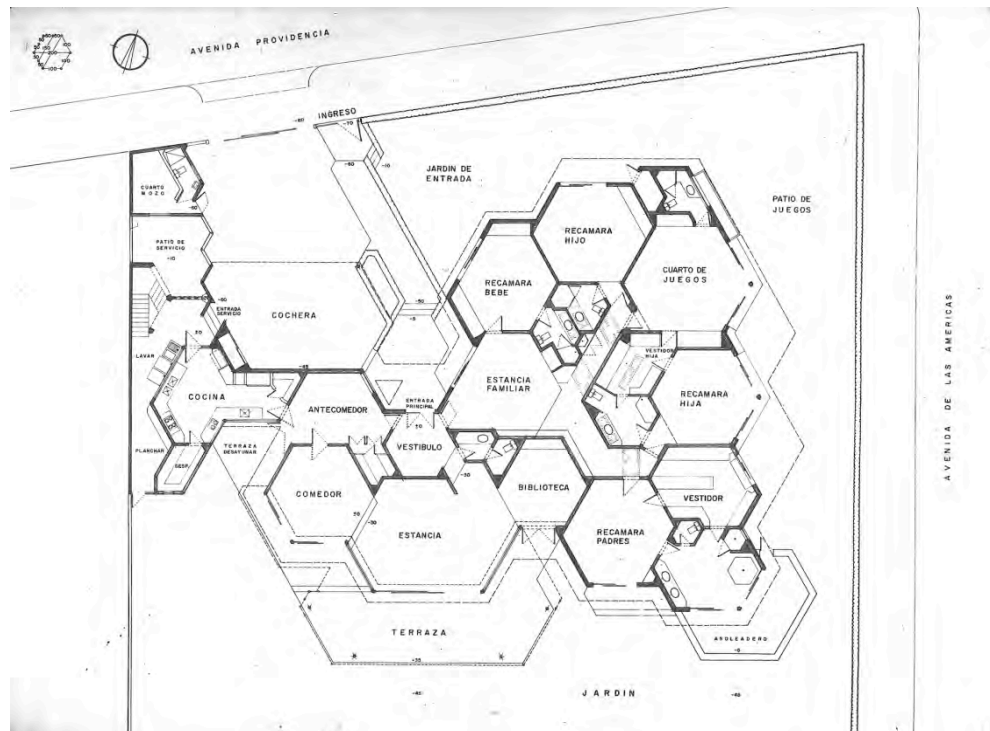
Haus Arregui (1969-1970), Grundriss
